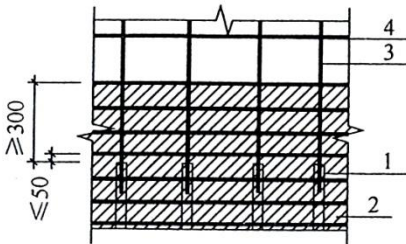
钢筋套筒灌浆连接部位水平分布钢筋的加密构造示意
